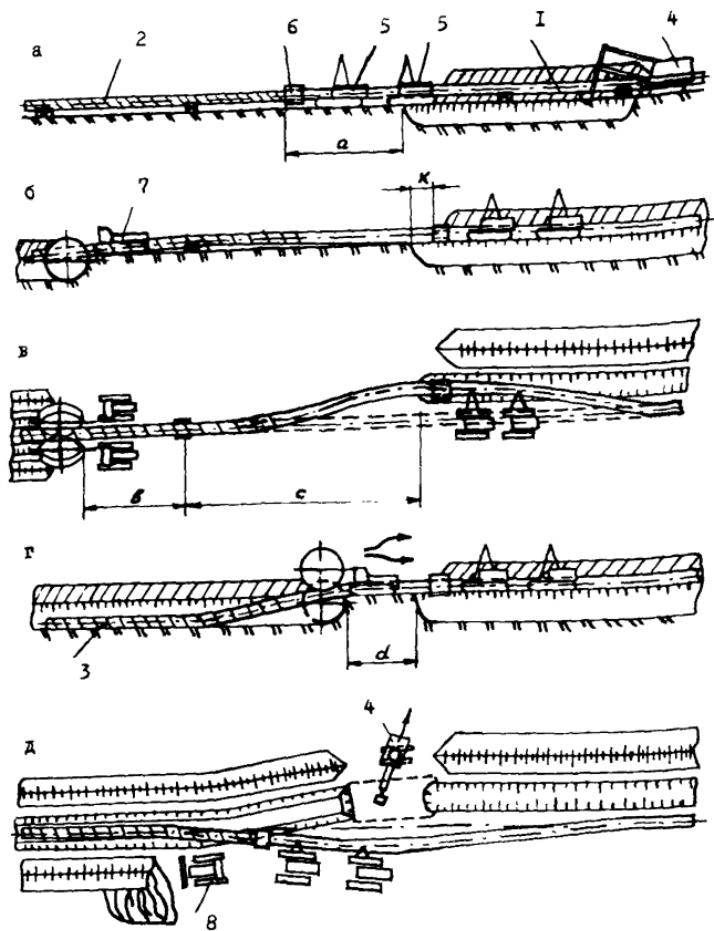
Переход от бесподъемной укладки к совмещенной традиционной при помощи трубоукладчика:
